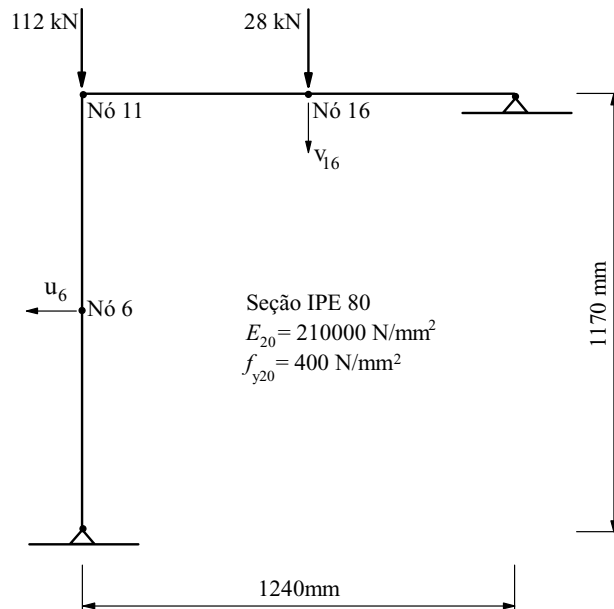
Exemplo 5: Pórtico com uma viga e um pilar
